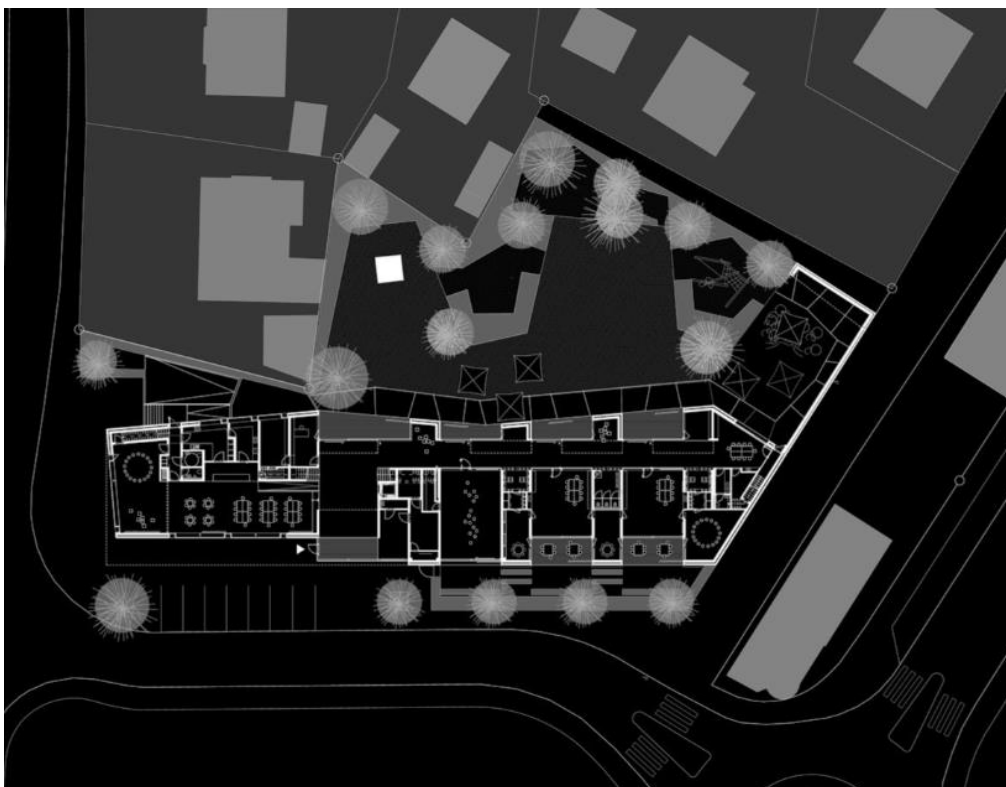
План першого поверху[<https://www.baechlemeid.de/projekte/haus-josefine-kramer>]
